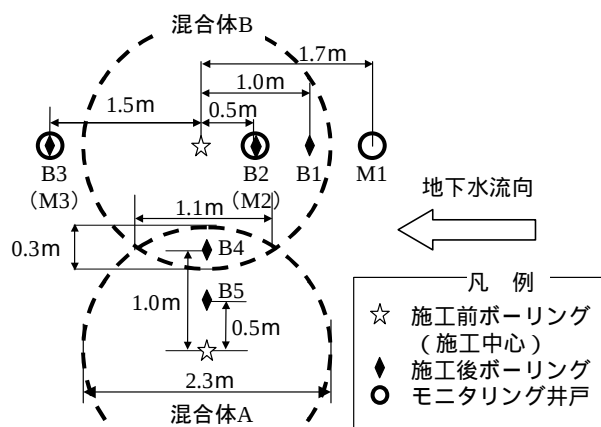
ボーリングサンプル及び地下水サンプル採取井戸配置の平面図
